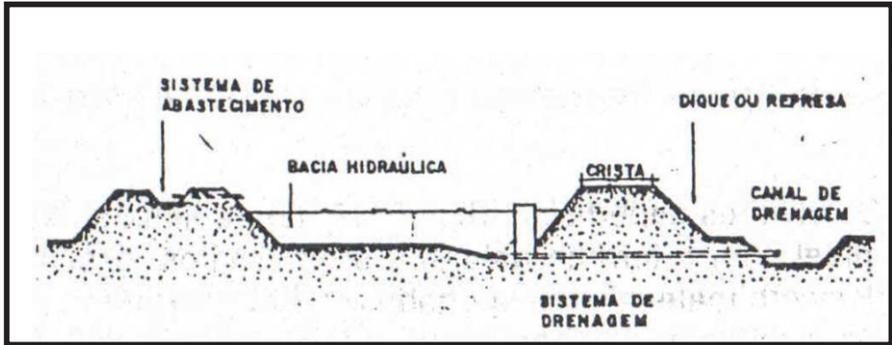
Viveiro Escavado - Entrada e Saída com lados opostos
